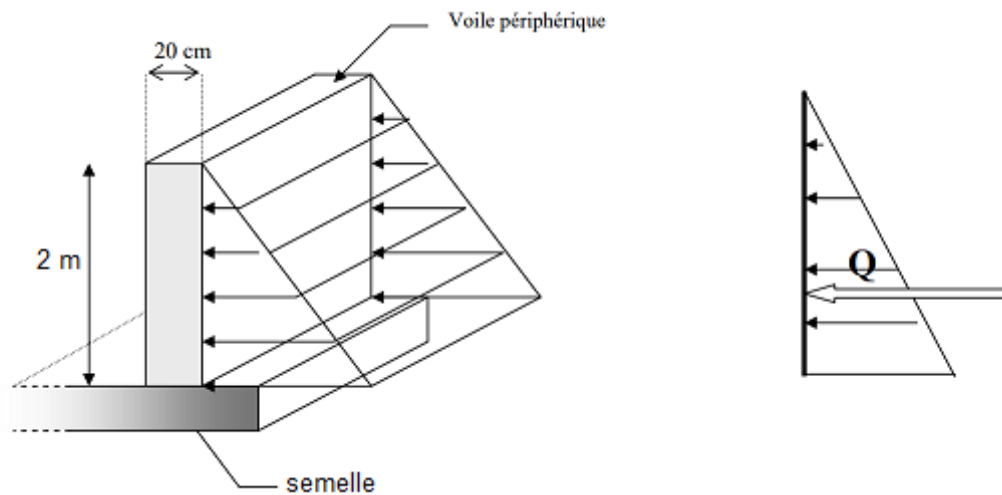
la poussée de la terre sur le voile periphérique.
